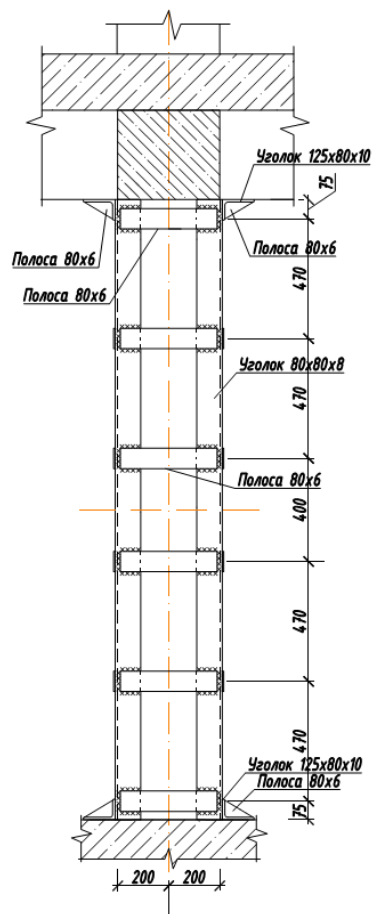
Усиление узла с помощью устройства разгружающей металлической обоймы на смежных этажах усиливаемого узла
